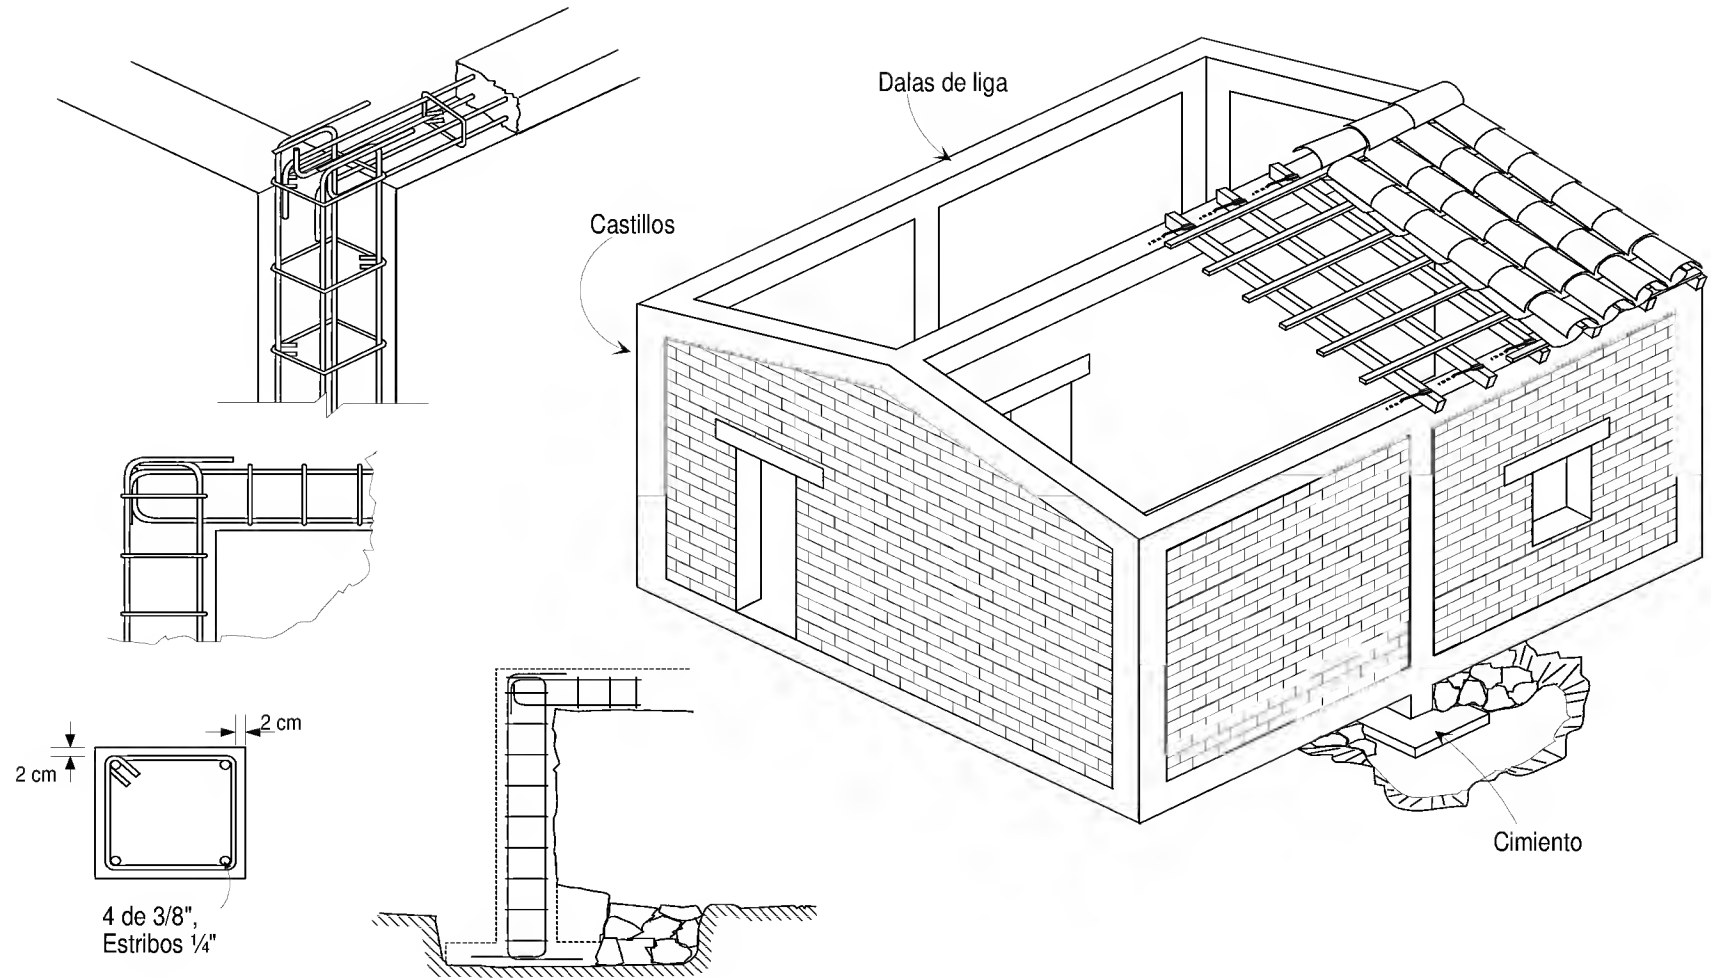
Refuerzo de una vivienda de autoconstrucción colocando elementos de liga como castillos y dalas
